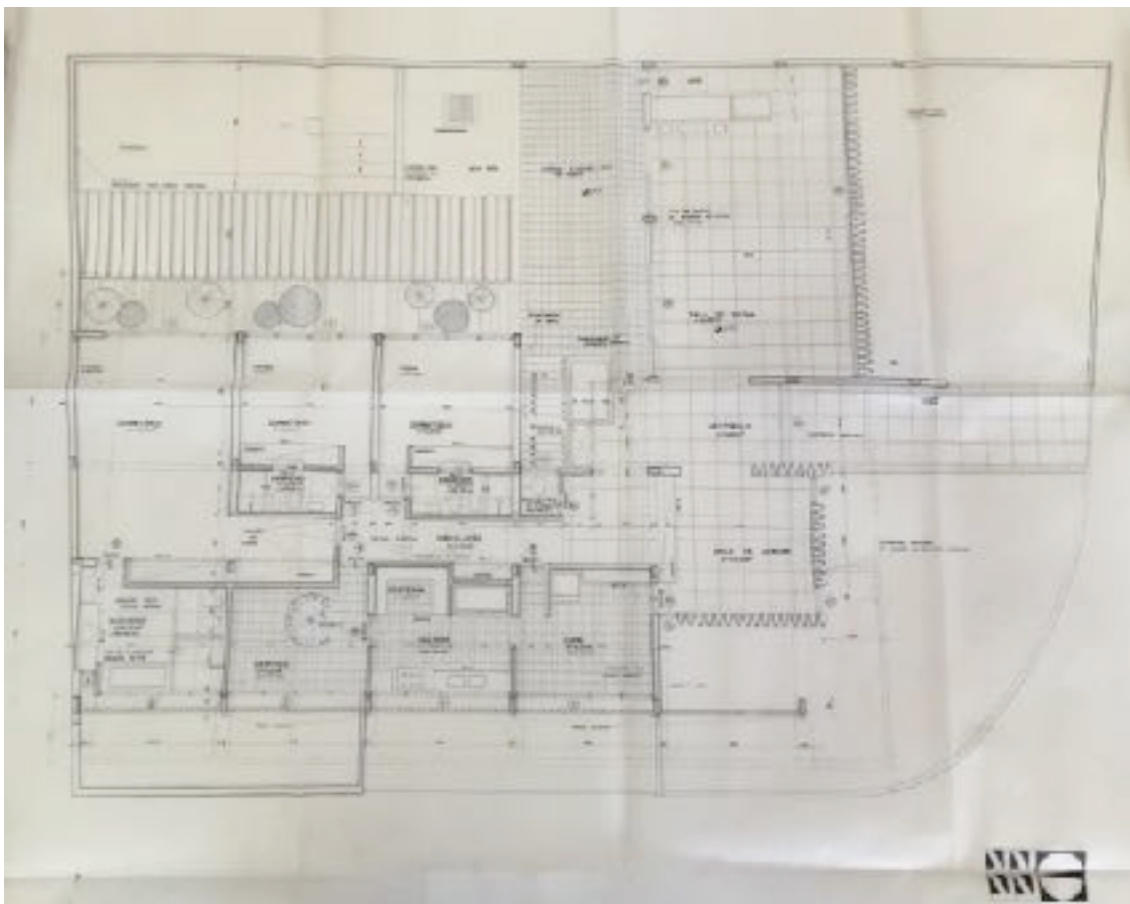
Planta Primeiro Pavimento Residência Fernando Monteiro. Fonte: NPD FAU UFRJ.
